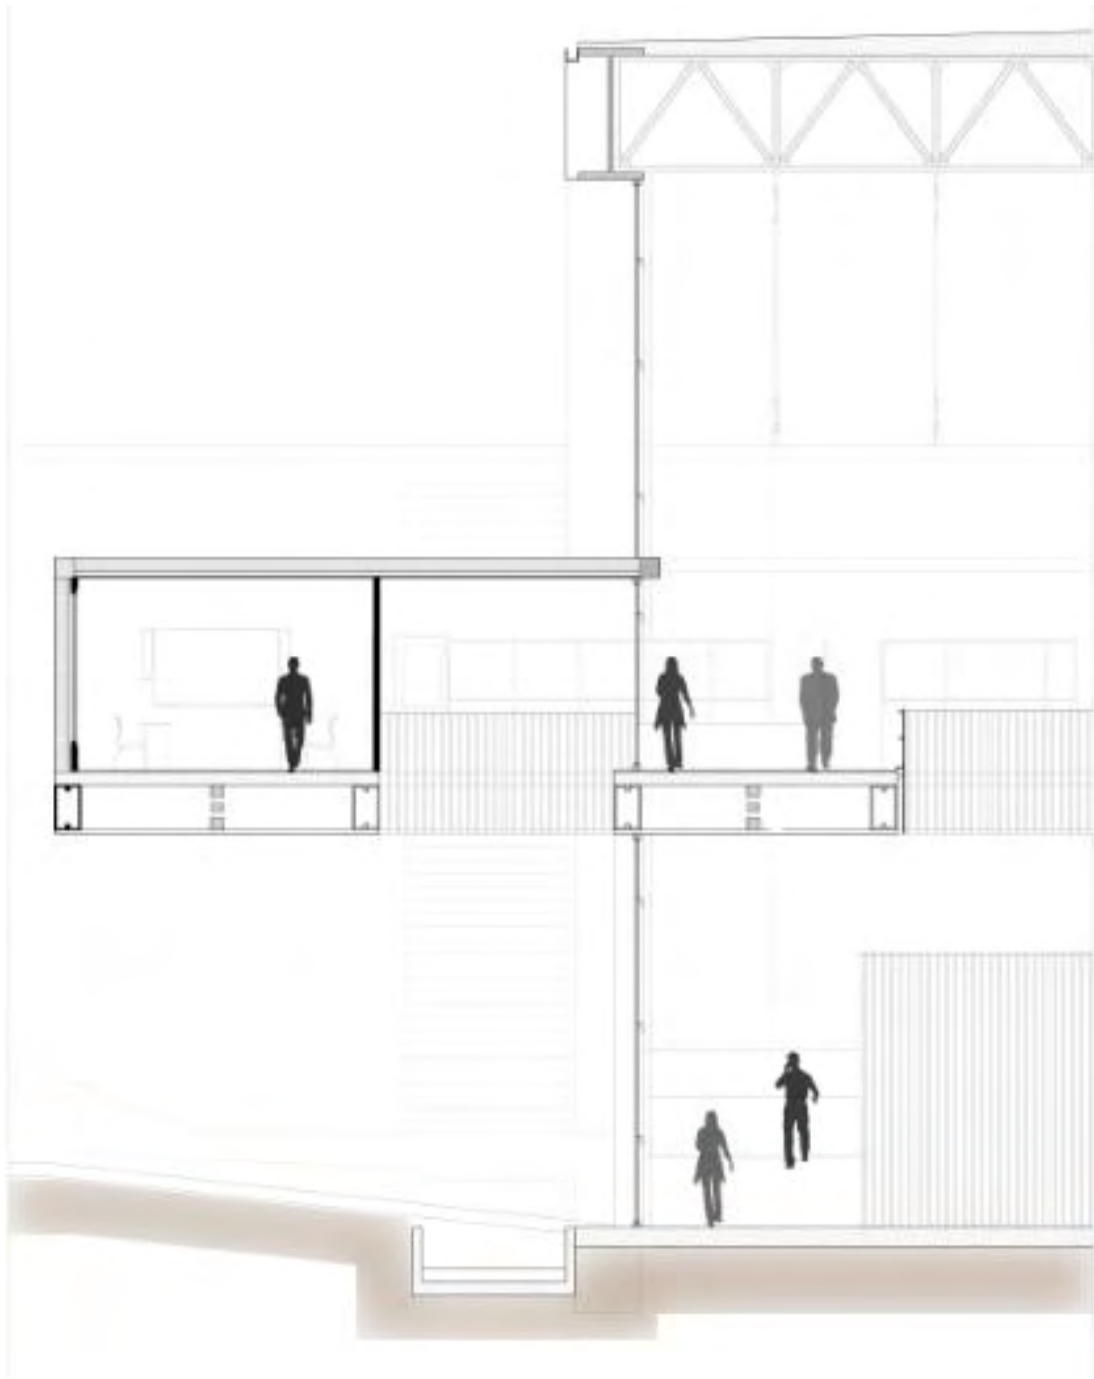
Corte Fachada 03. Fuente: Elaboración propia
